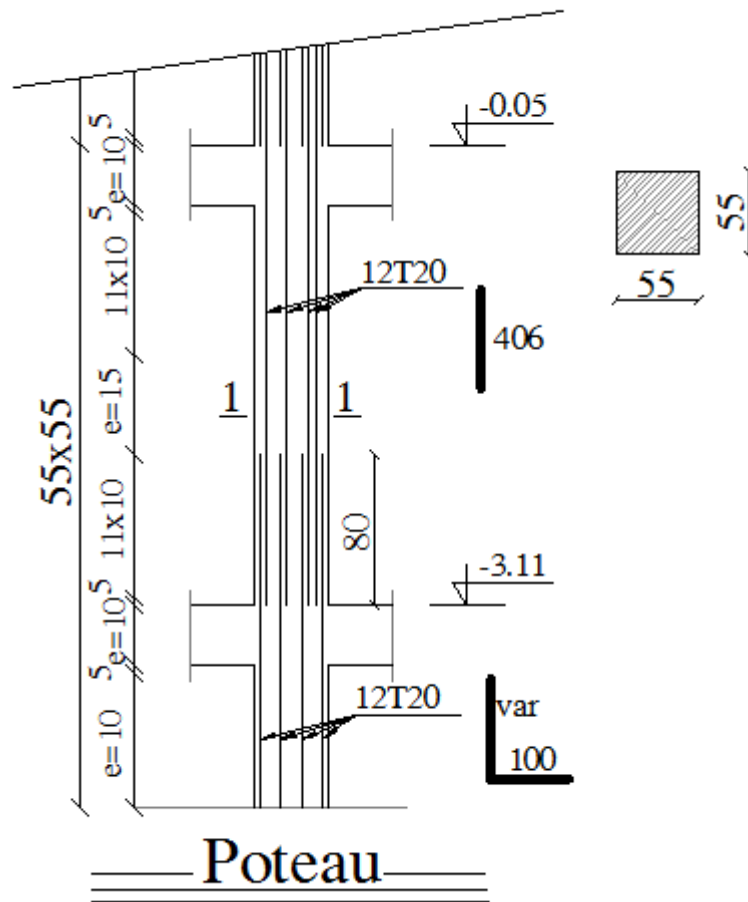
Schéma de la coupe de ferrailage de poteau en élévation.
